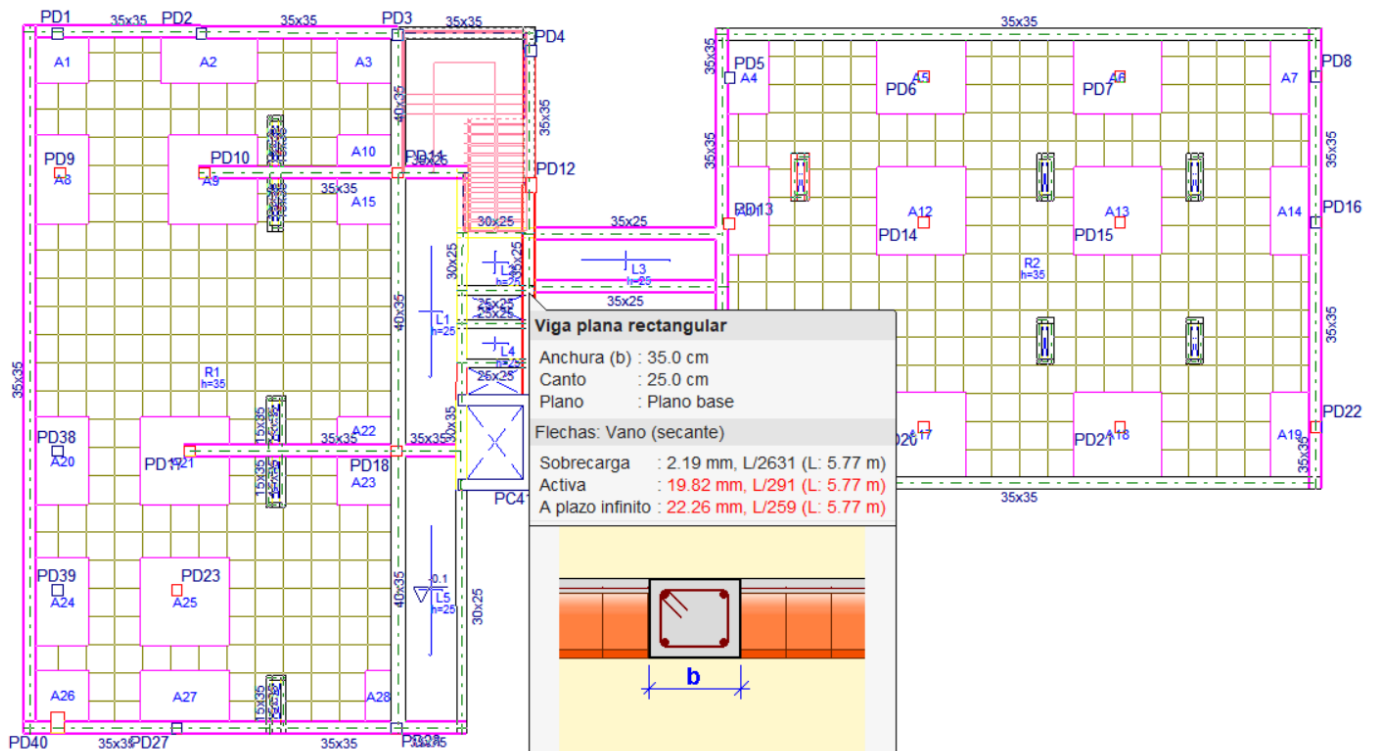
Flechas en Vigas, Planta Segunda, Módulo D
